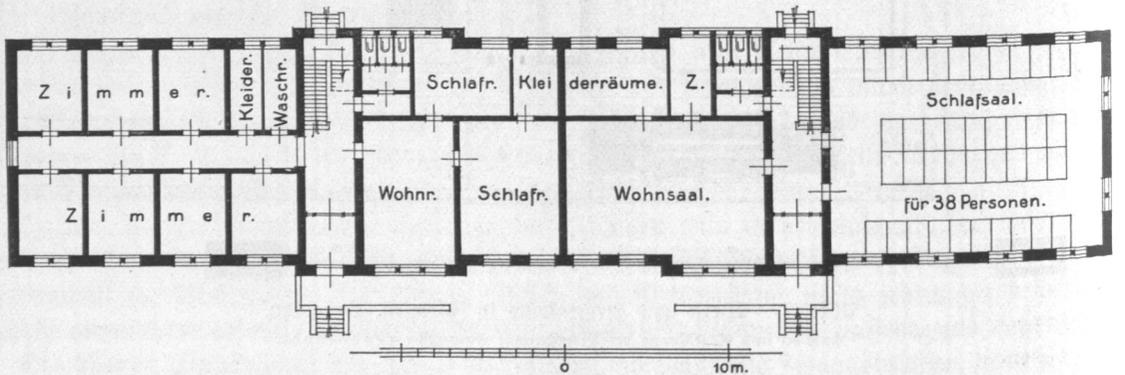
Werk- und Armenhaus in Farmsen, großes Einzelhaus, Grundriß.
